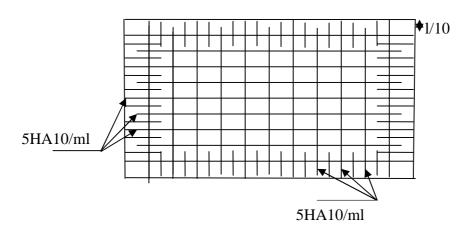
Vue en plans du ferraillage de la dalle de la salle machine
